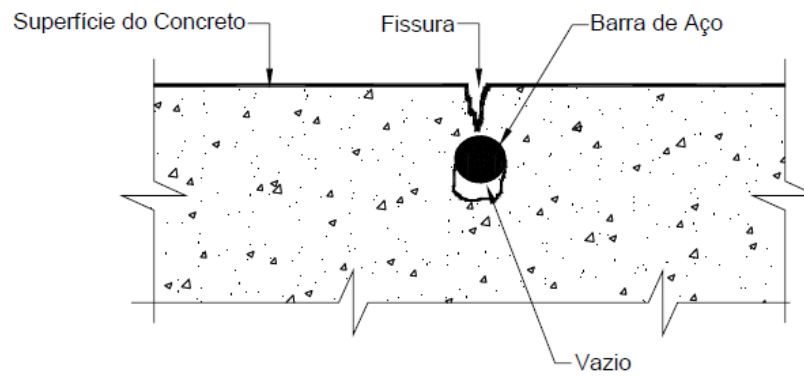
Fissuras por Perda de Aderência e Colapso da Ancoragem da Armadura
